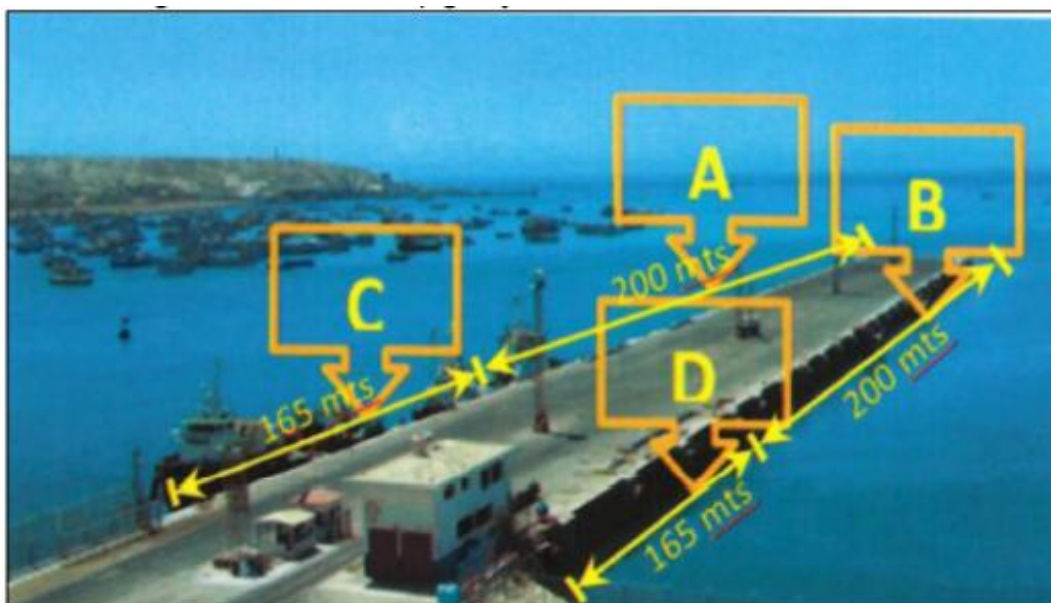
Muelle espigón y su distribución de amarraderos
